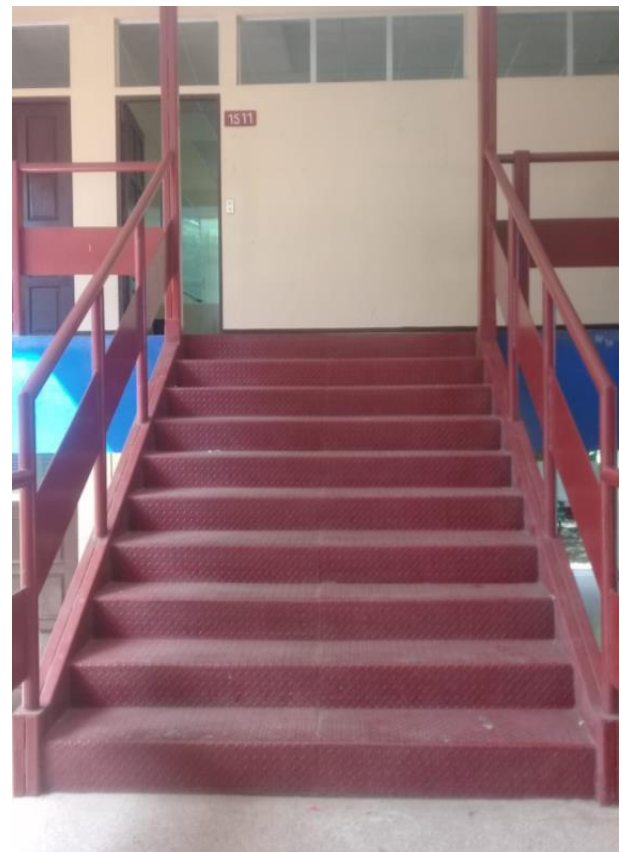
Vista Frontal, Escaleras metálicas Pabellón 15.
